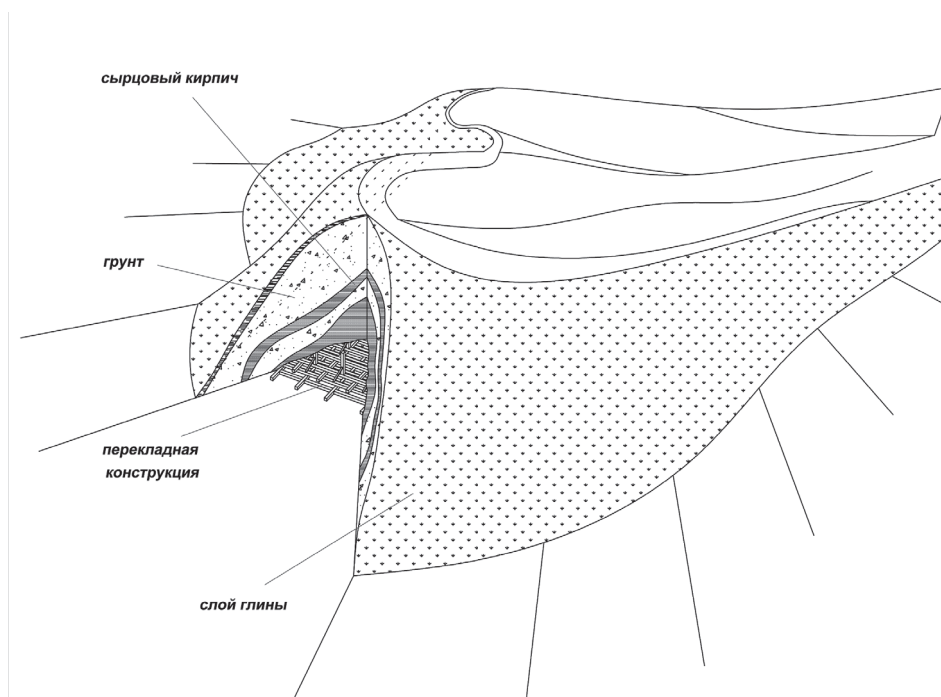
Аксонометрический разрез вала форта Верный (Е. Демидова)
